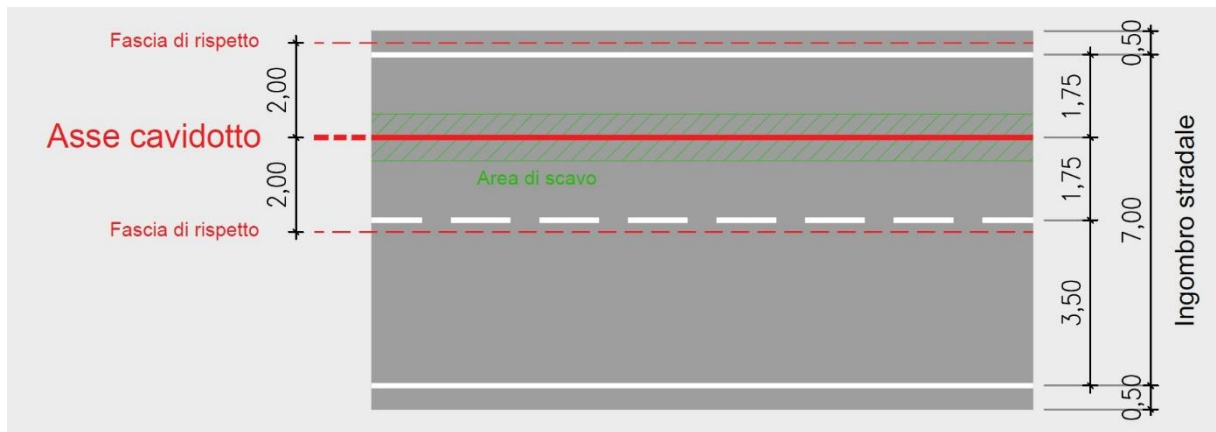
Schema esplicativo della fascia di rispetto del cavidotto
